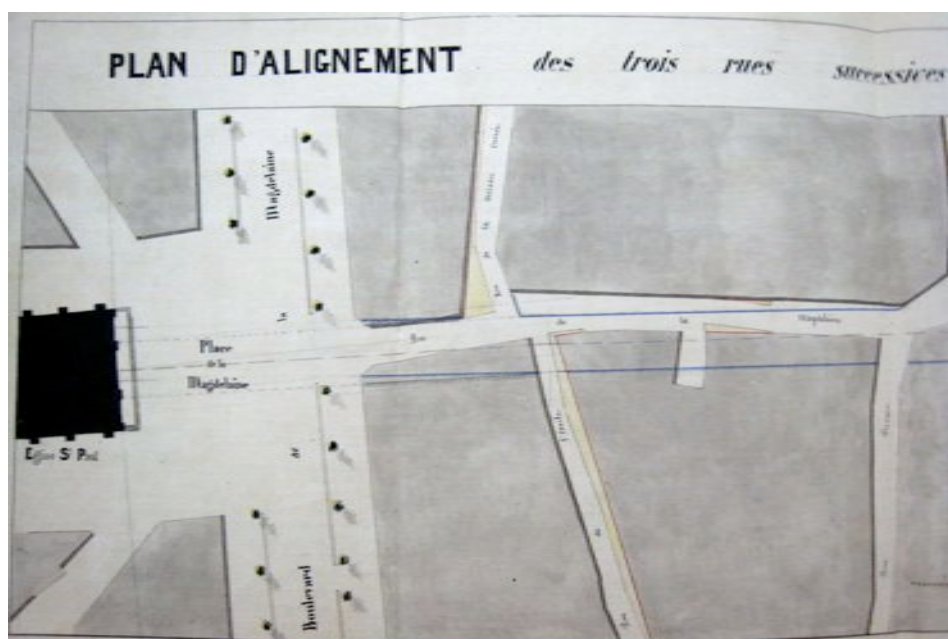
Plan d'alignement après l'implantation de l'église Saint-Paul - (ADG)
